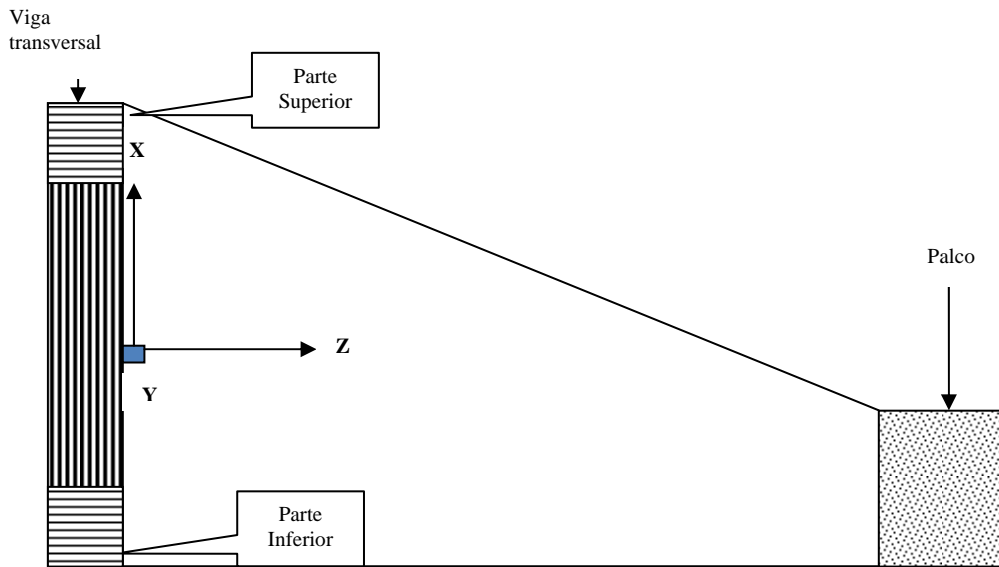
Puntos y direcciones de medición en la viga transversal y el palco
